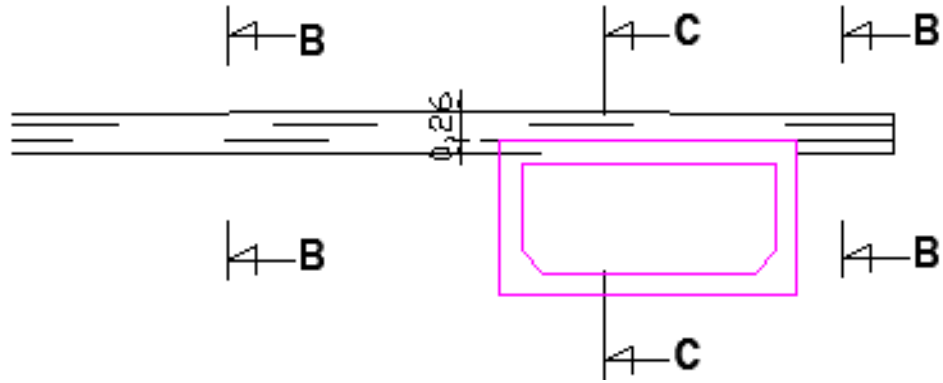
a: Corte sección canal. EDET RD-L.
